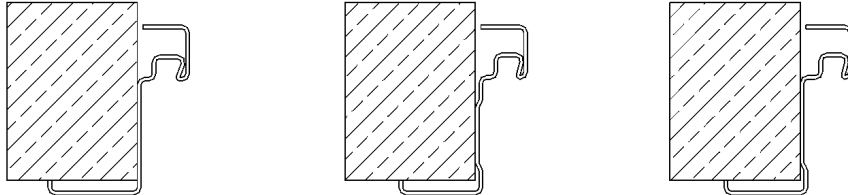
Mocowanie uszczelki pęczniającej: a) w ościeżnicy, b) w skrzydle
